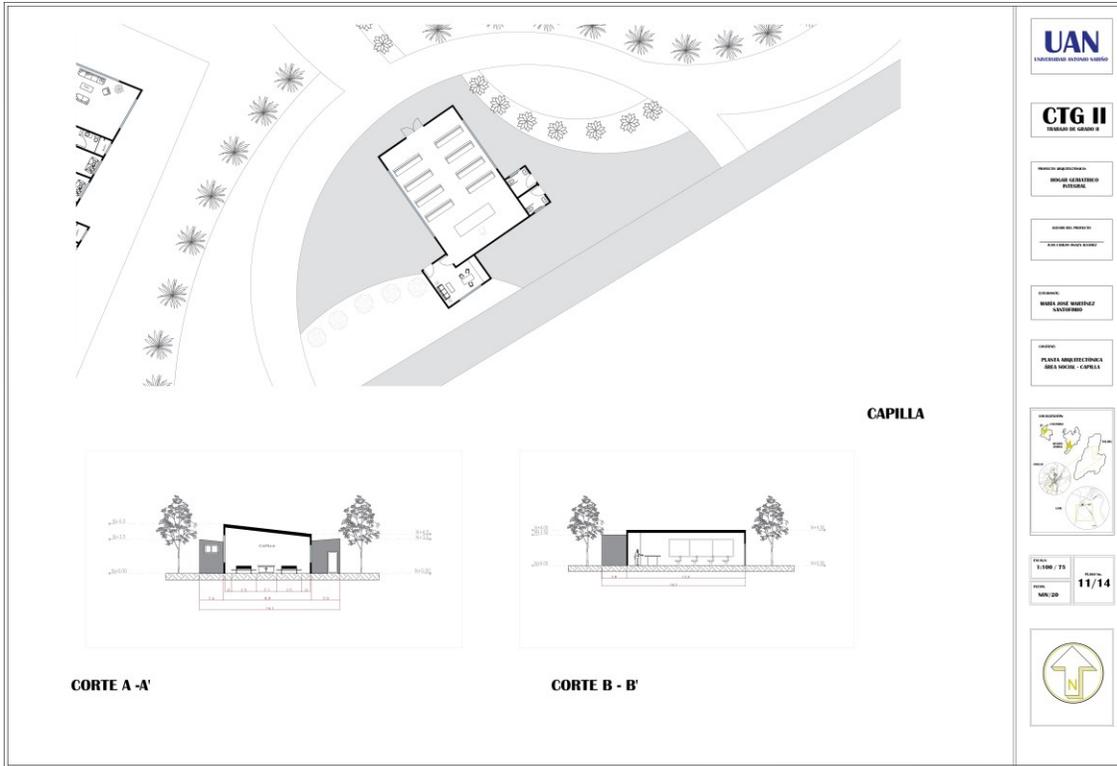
Planimetría capilla. Fuente. Autoría Propia.
